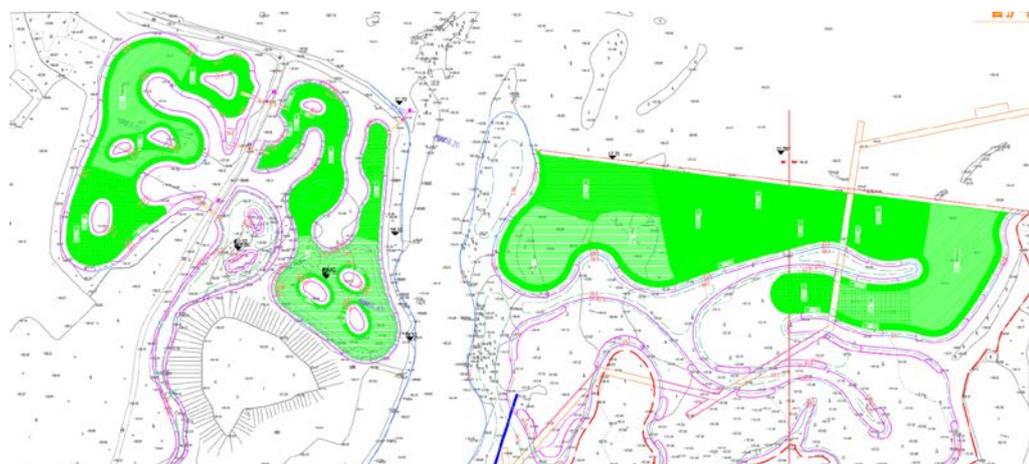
果树河河口湿地沉水植物平面布置
